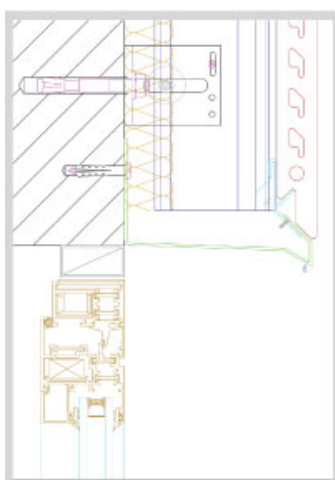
Aplicação da fachada ventilada – Janela – secção vertical superior [47]
